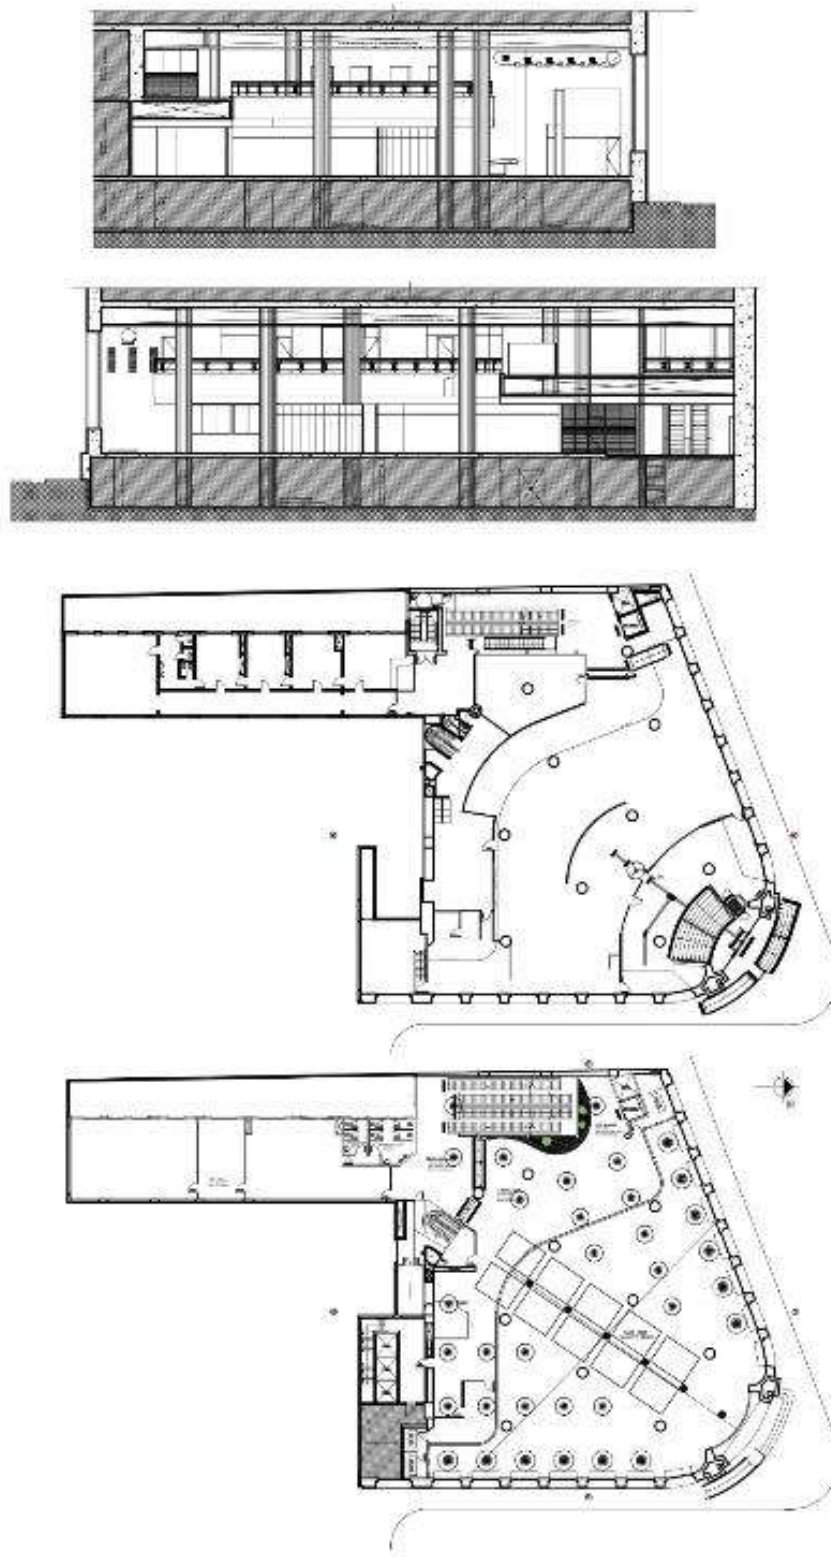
Topo*: corte longitudinal I; *Segunda imagem de cima pra baixo*: corte longitudinal II; *Terceira imagem de cima pra baixo*: planta baixa térreo; *Base*: planta baixa forro.
